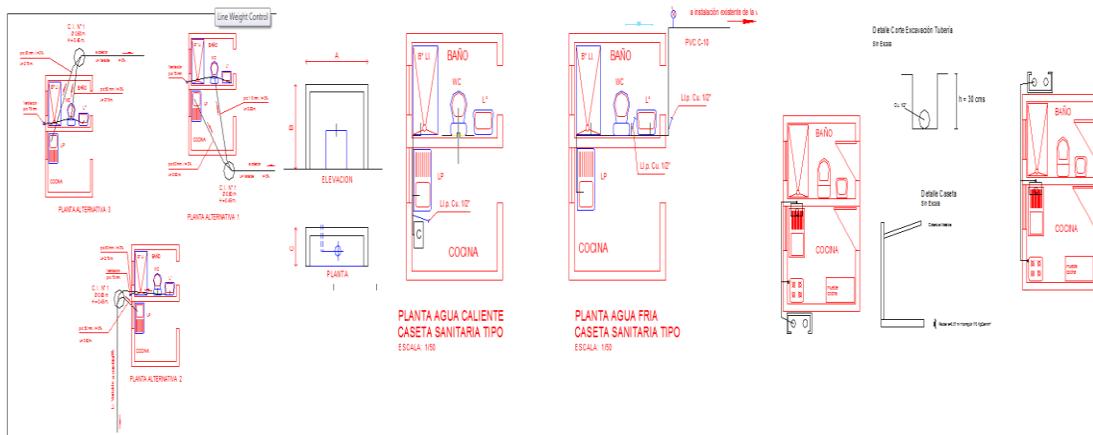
Extracto de planos “Casetas Panguesillos”
